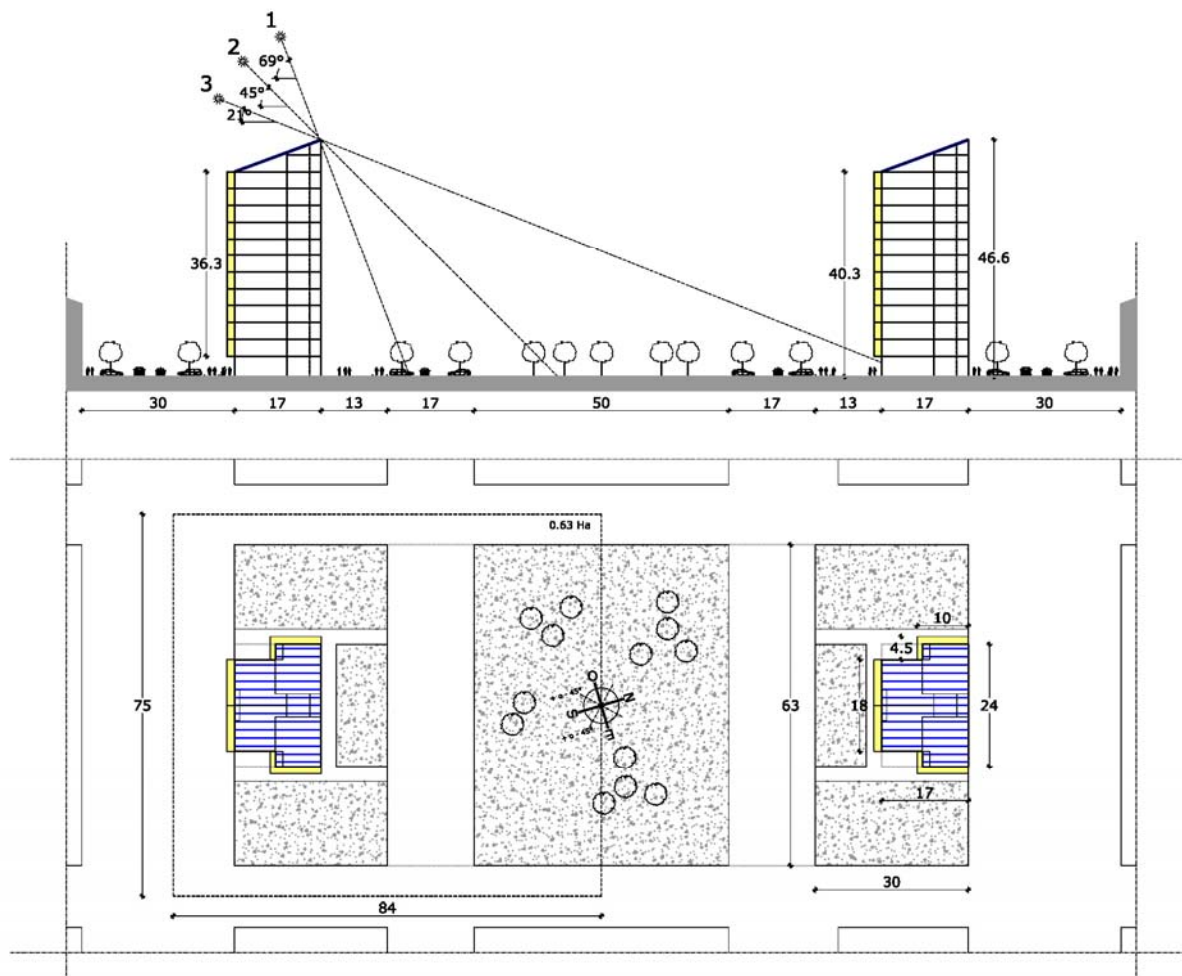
Sezione ambientale e schema planimetrico della UMTU, indicata col tratteggio
